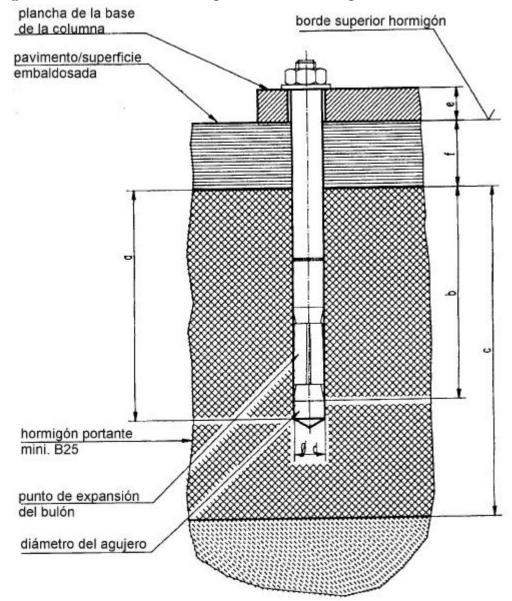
Elección de los tornillos para 2.30 SL E con pavimento o baldosas
